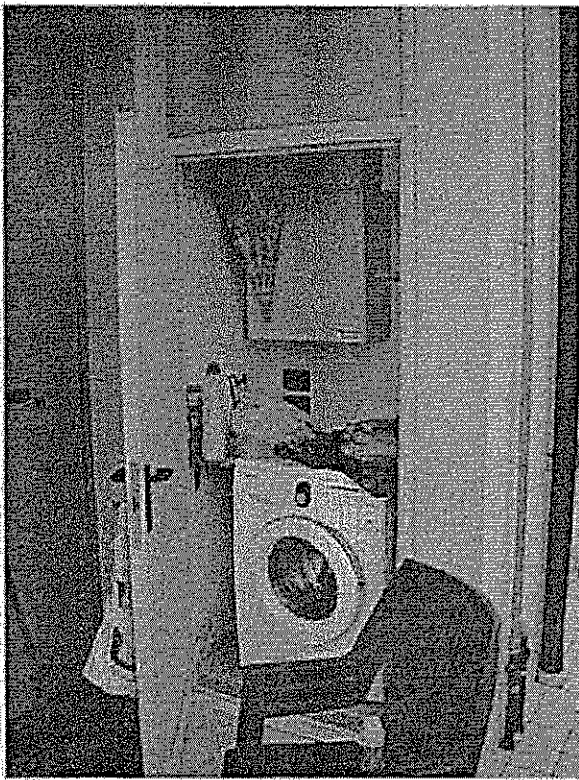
Vista della porzione della loggetta antistante il locale cucina-soggiorno, ove sono ubicati la caldaia e gli attacchi per la lavatrice.
